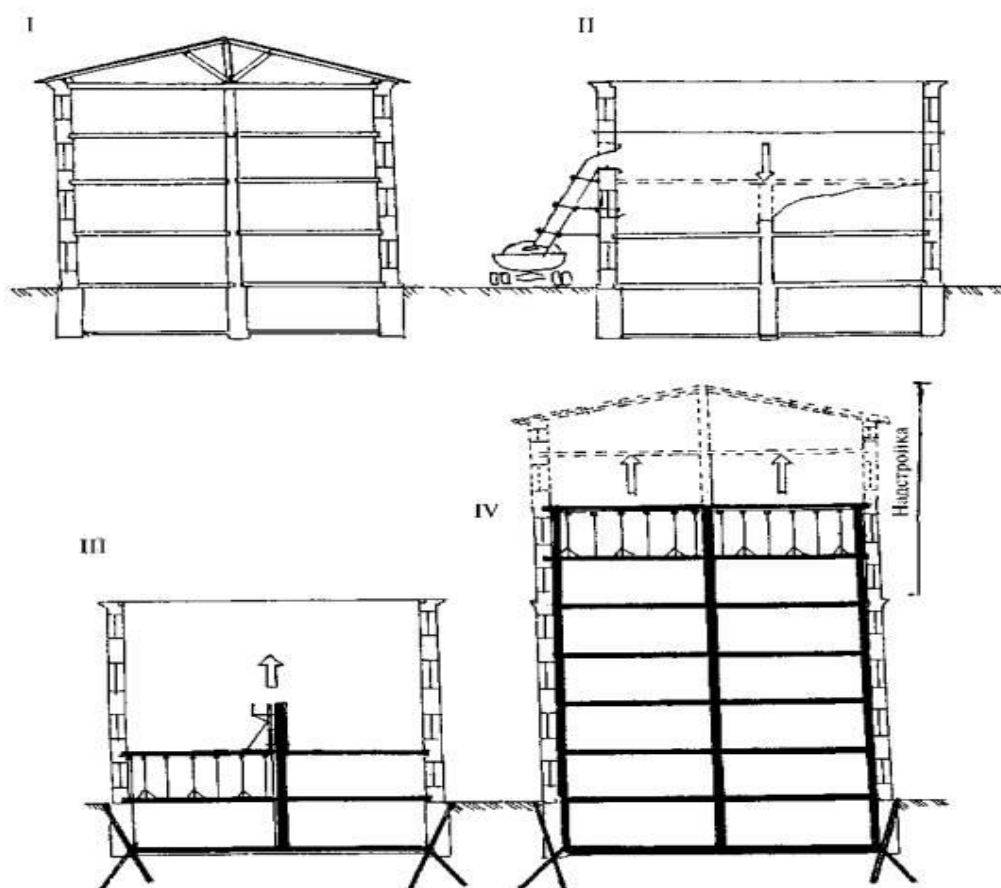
Технологическая последовательность реконструкции зданий методом встроенных строительных систем с надстройкой этажей
